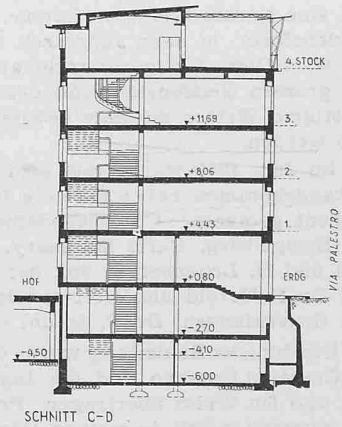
Schnitt durch den Dachgarten Masstab 1:500
